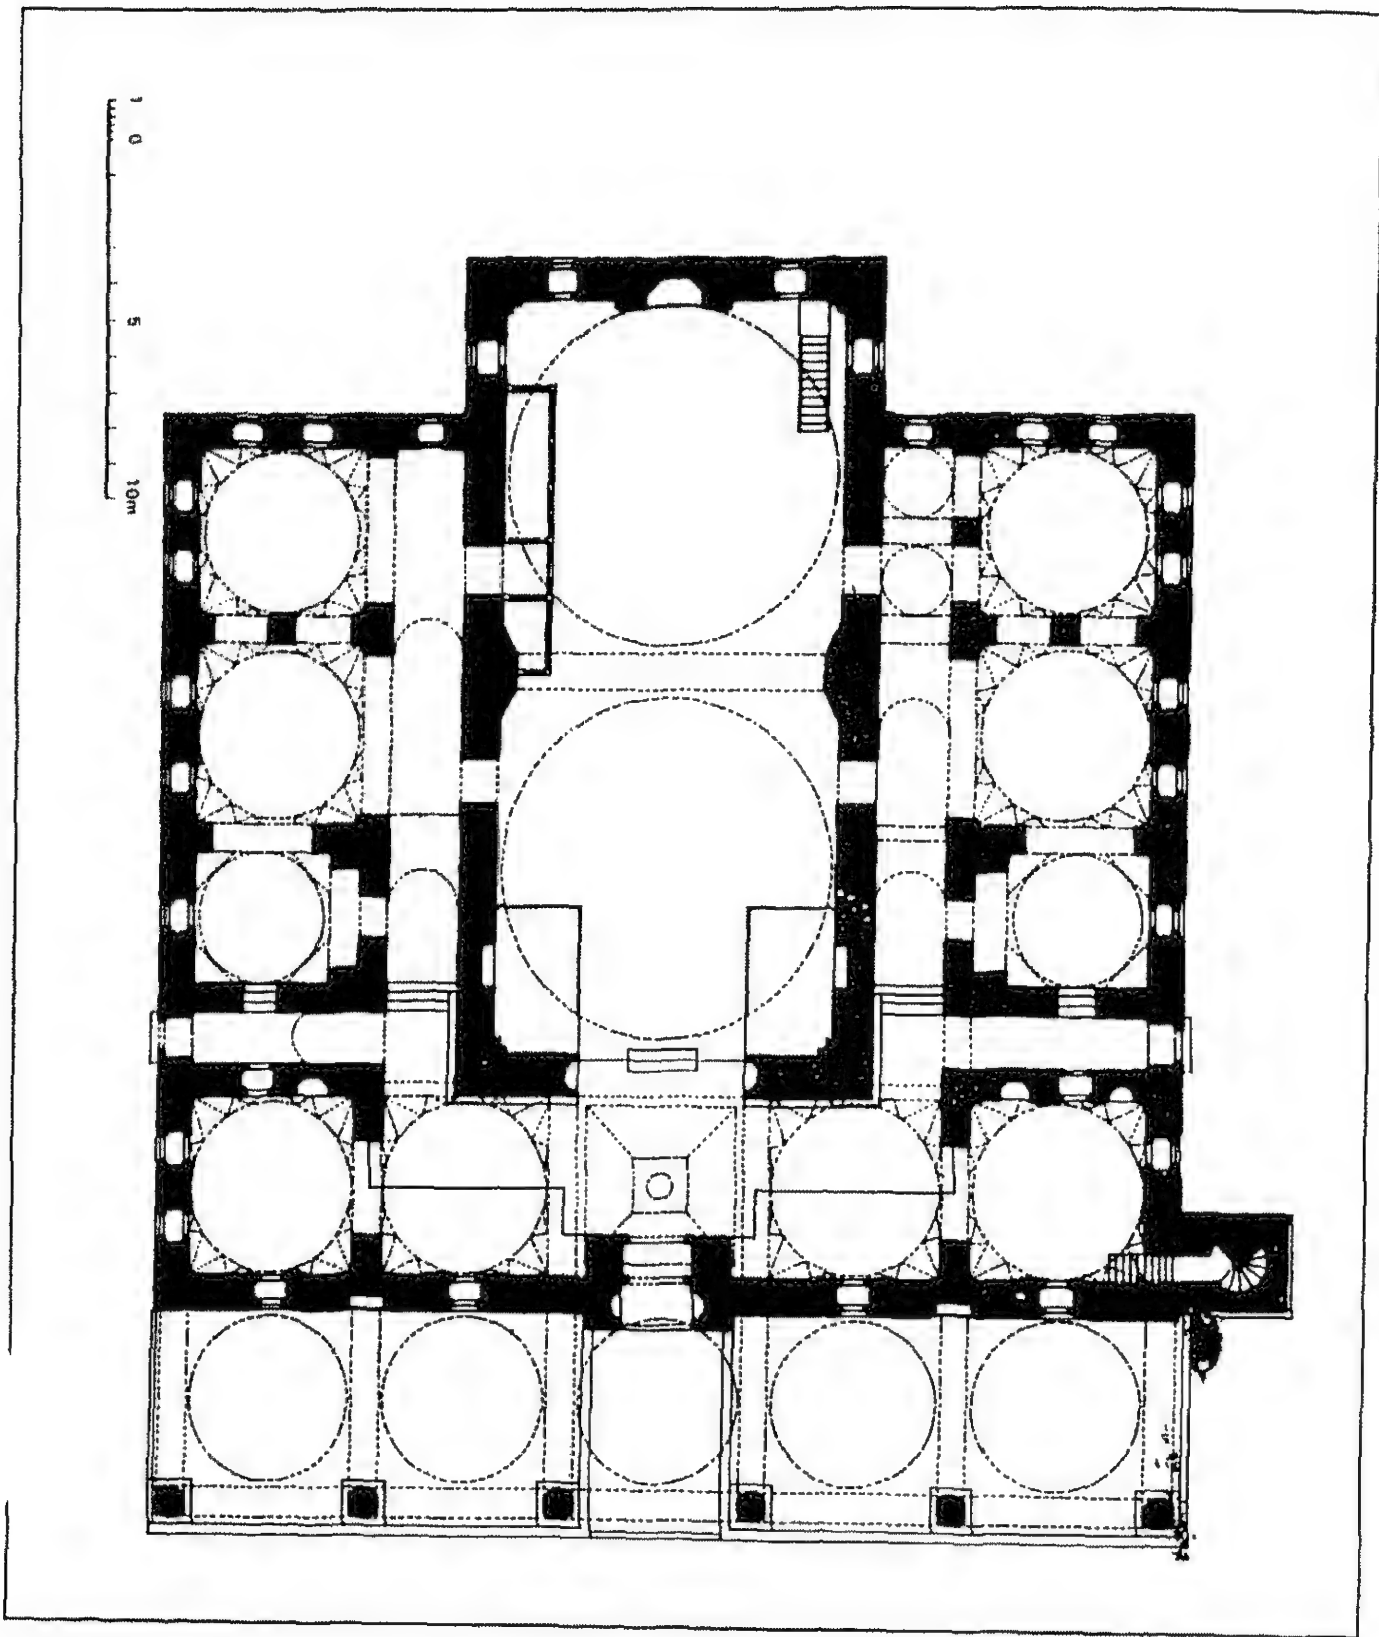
مسقط أفقي لمسجد شهاب الدين باشا في فيلبه (عن : أصلان أبا)
